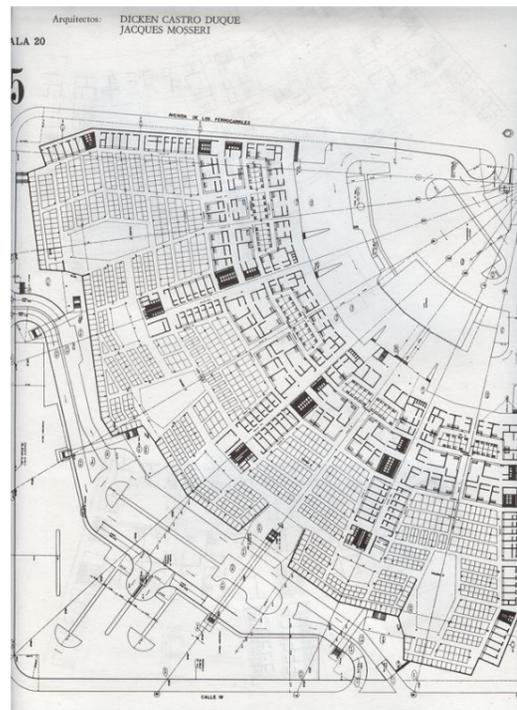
Planta de la Plaza de Mercado de Paloquemao. Fuente: Revista Escala # 20 - Centro de Abastos (1967)
